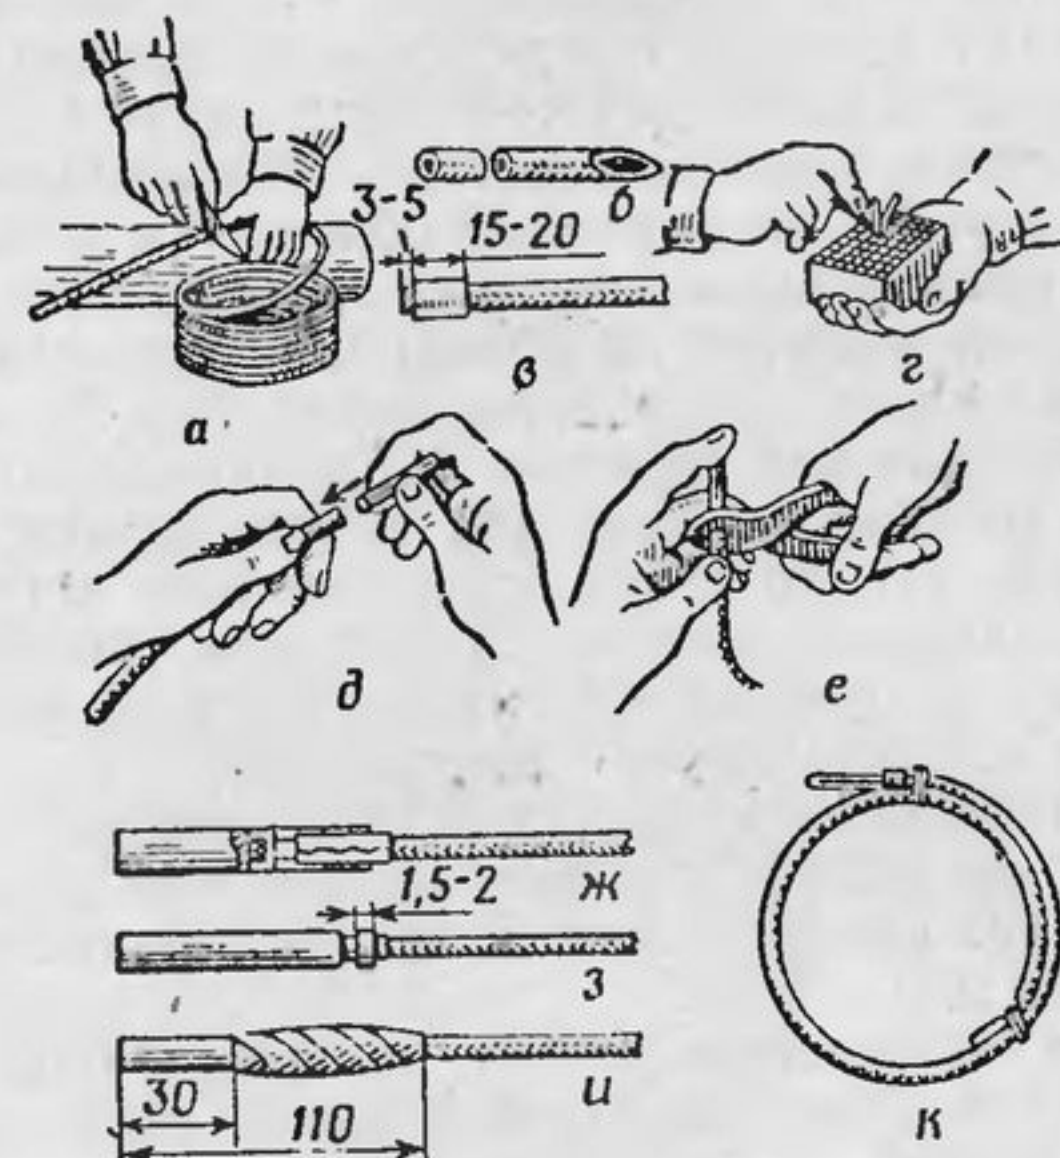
Порядок изготовления зажигательной трубки (размеры в мм):
